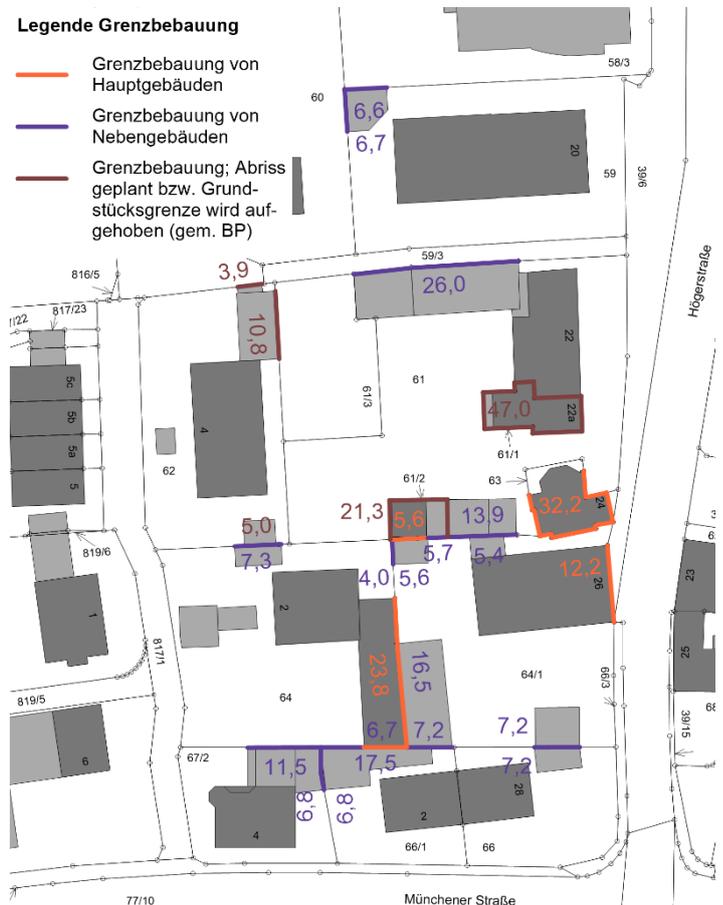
vorhandene Grenzbebauungen im Plangebiet, ohne Maßstab
